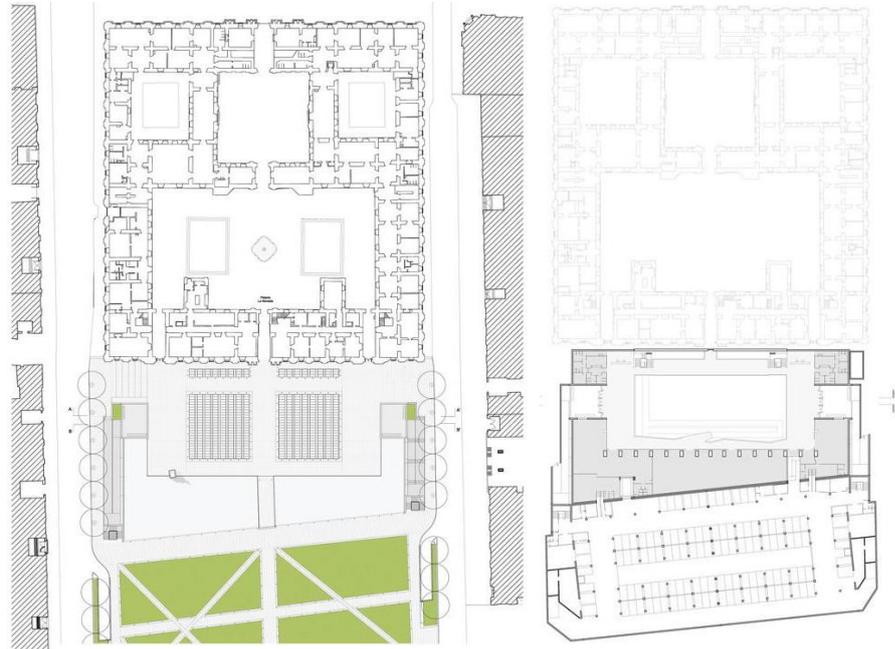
Plantas del primer nivel y Sótano 1. Fuente: Archdaily, 2006. Elaboración: Imagen de cortesía de Undurraga Devés Arquitectos, 2006. Blog Diseño Arquitectura.
